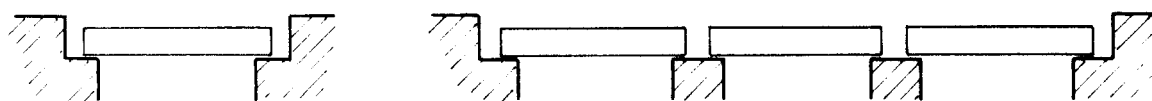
Sistema de ponte em viga com um ou vários tramos simplesmente apoiados.
